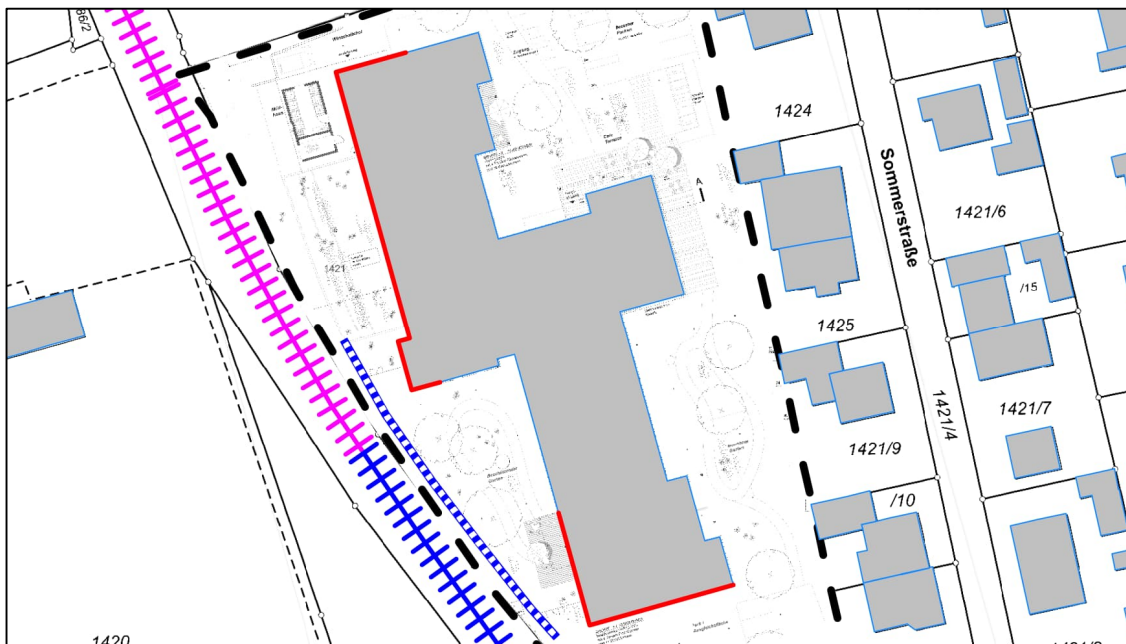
Lageplan mit Kennzeichnung der Fassaden, an denen passive Schallschutzmaßnahmen auf Höhe des Erdgeschosses notwendig sind
